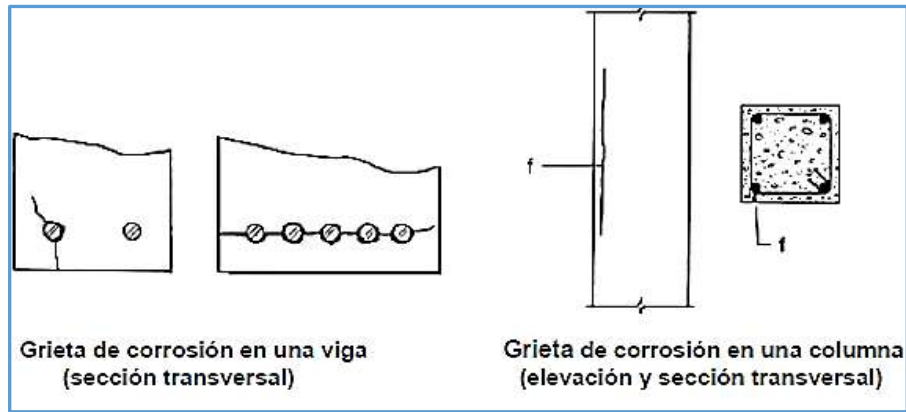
23. Grietas por corrosión en el acero. (Adaptado de Ottazzi, 2004).
